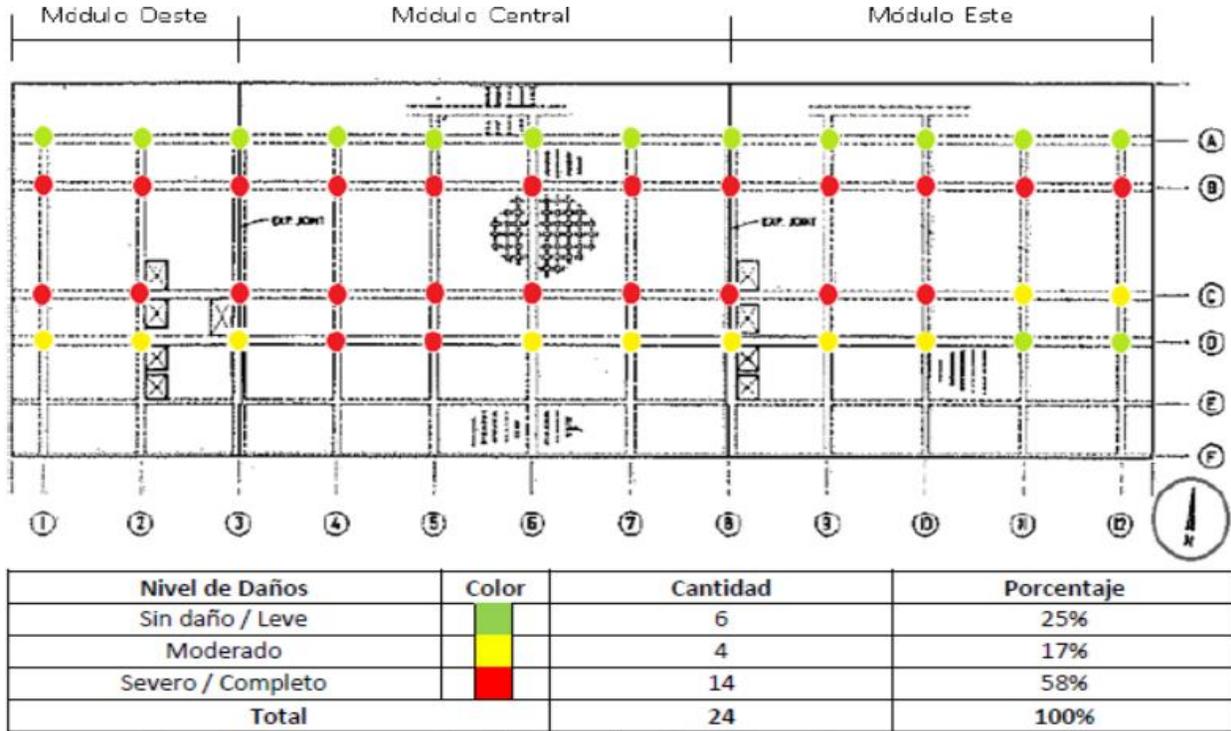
Esquema de la planta del piso crítico y número de columnas con daño, en el Módulo Central del Hotel Macuto Sheraton. Modificada de Hanson y Degenkolb, 1975.
